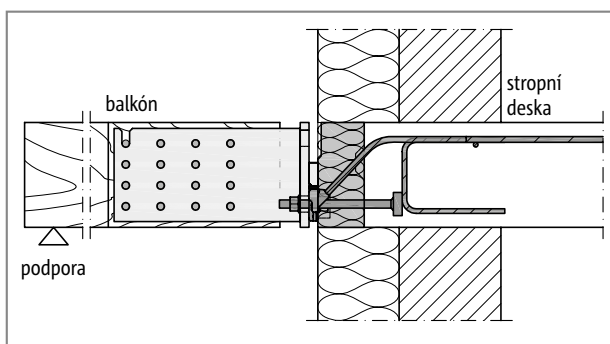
Schöck Isokorb® T typ SQP s přípojným adaptérem: Napojení na železobetonovou stropní desku; izolant uvnitř vnějšího zateplení
